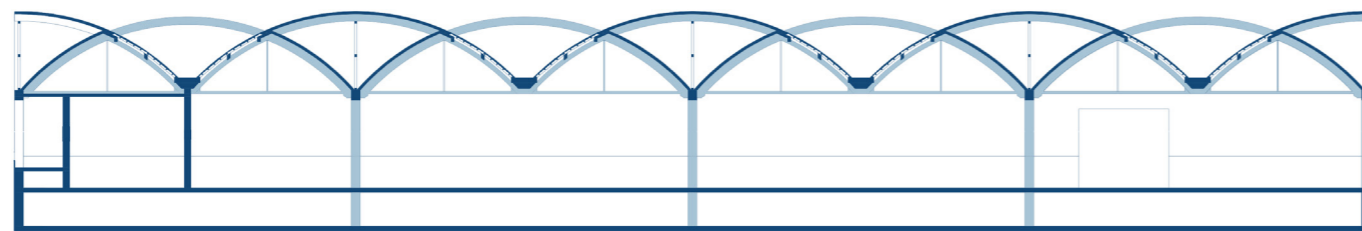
Schema in cui si evidenzia la sezione della struttura portante dell'edificio
